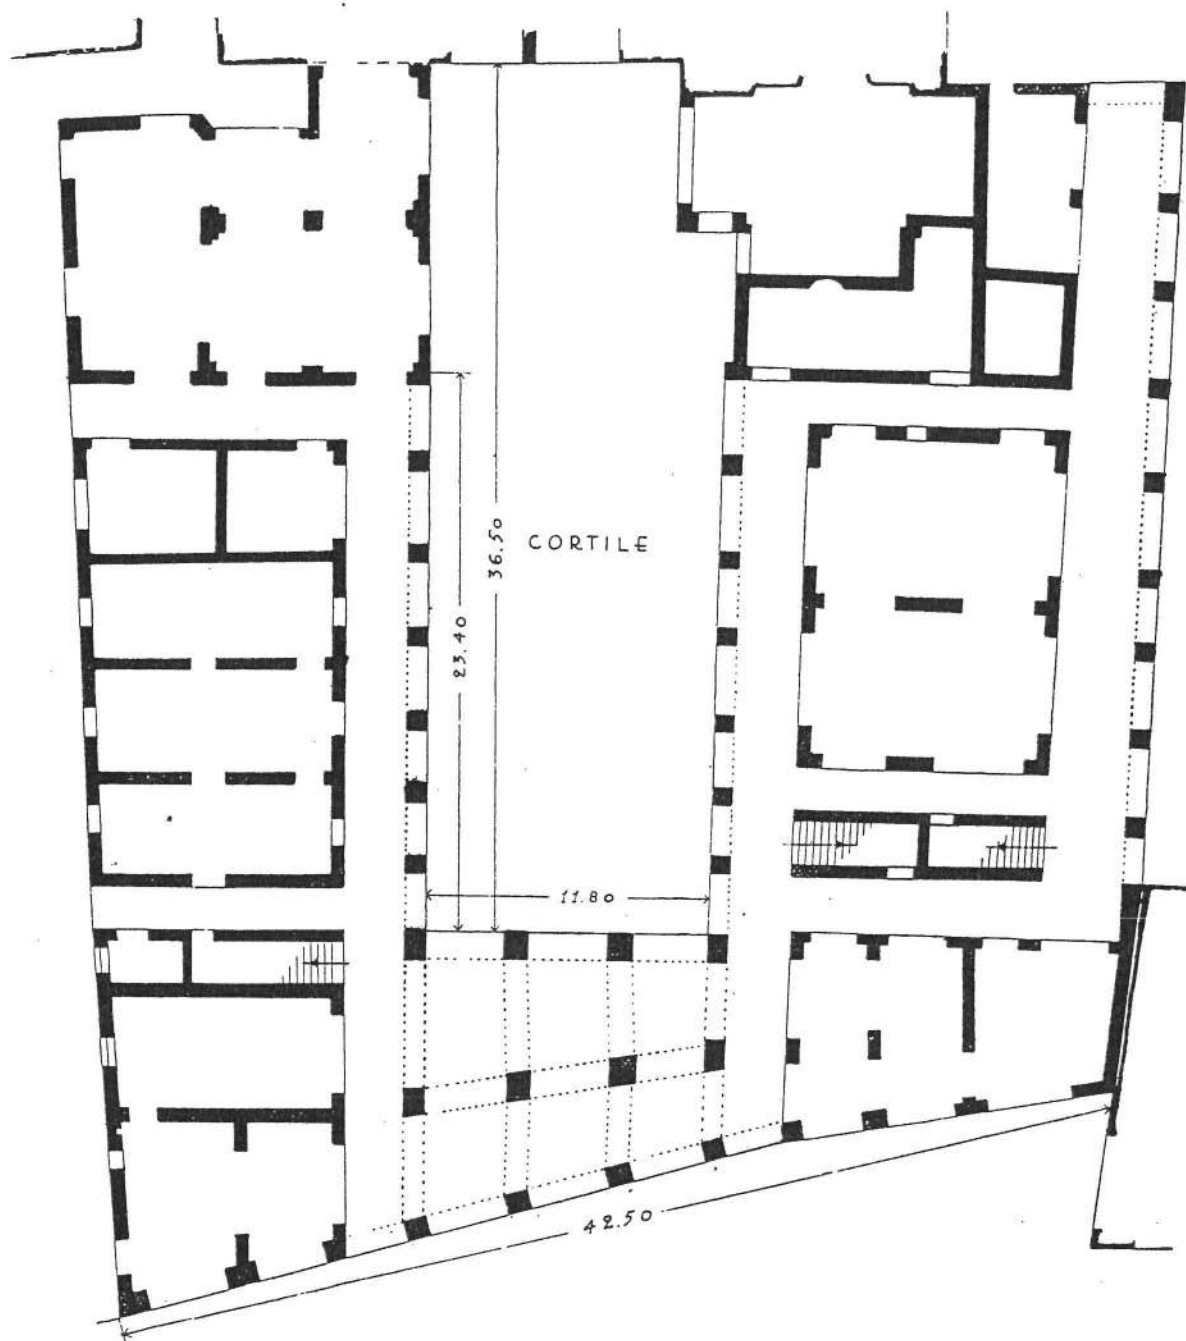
CASA DETTA DEGLI AURIGHI: PIANTA DELL'EDIFICIO ORIGINALE
